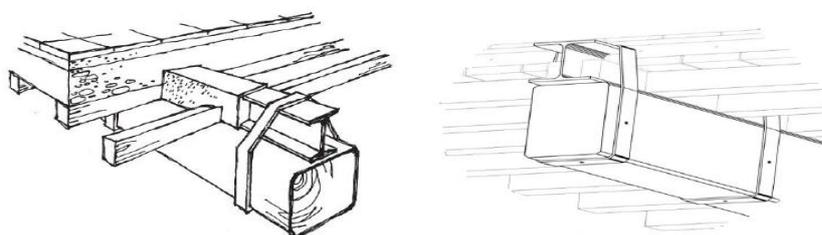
Propostas de reforço de viga através da colocação de perfil IPE ou HEA com cinta metálica (Gómez) (Mariani, 2004)
